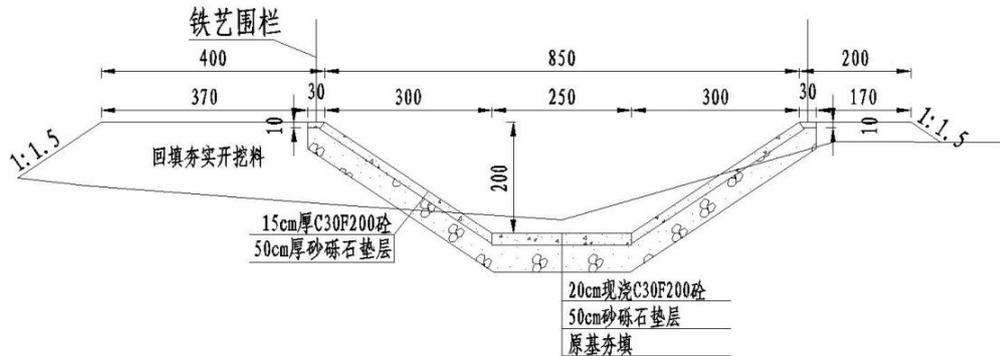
梯形断面标准横断面图 (0+551~1+170、1+324~2+626)
